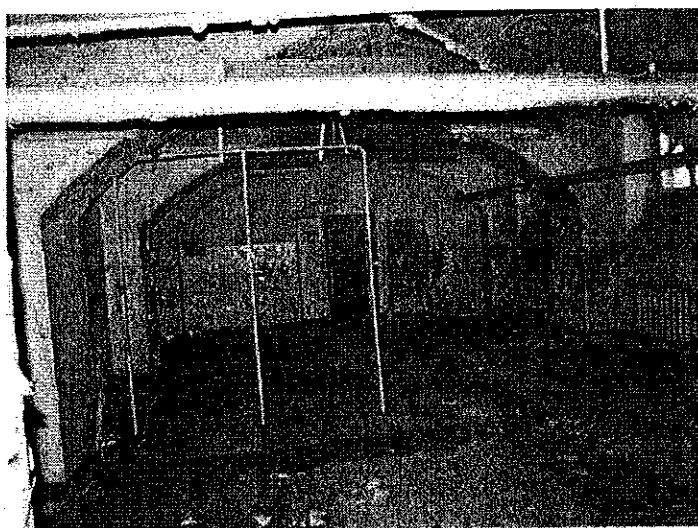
Elewacja północna - wtórne schody metalowe wprowadzone w miejscu pierwotnych murowanych.
